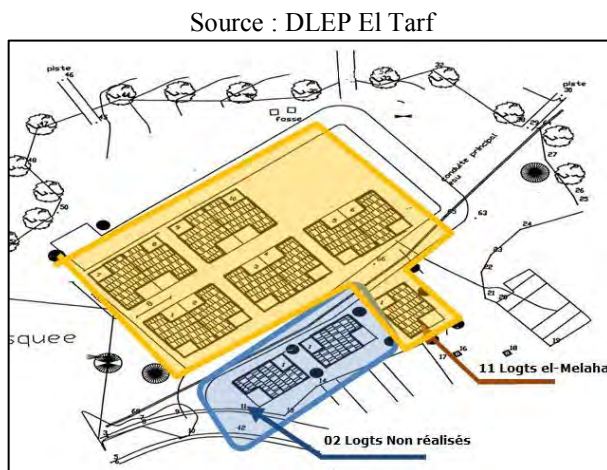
Plan de masse 11 logements ruraux «El Mélha».
